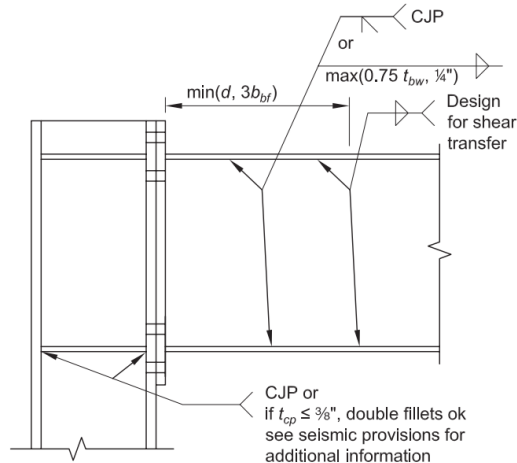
Detalles de soldadura en la viga y columna para perfiles soldados. Fuente: ANSI/AISC 358-22.
